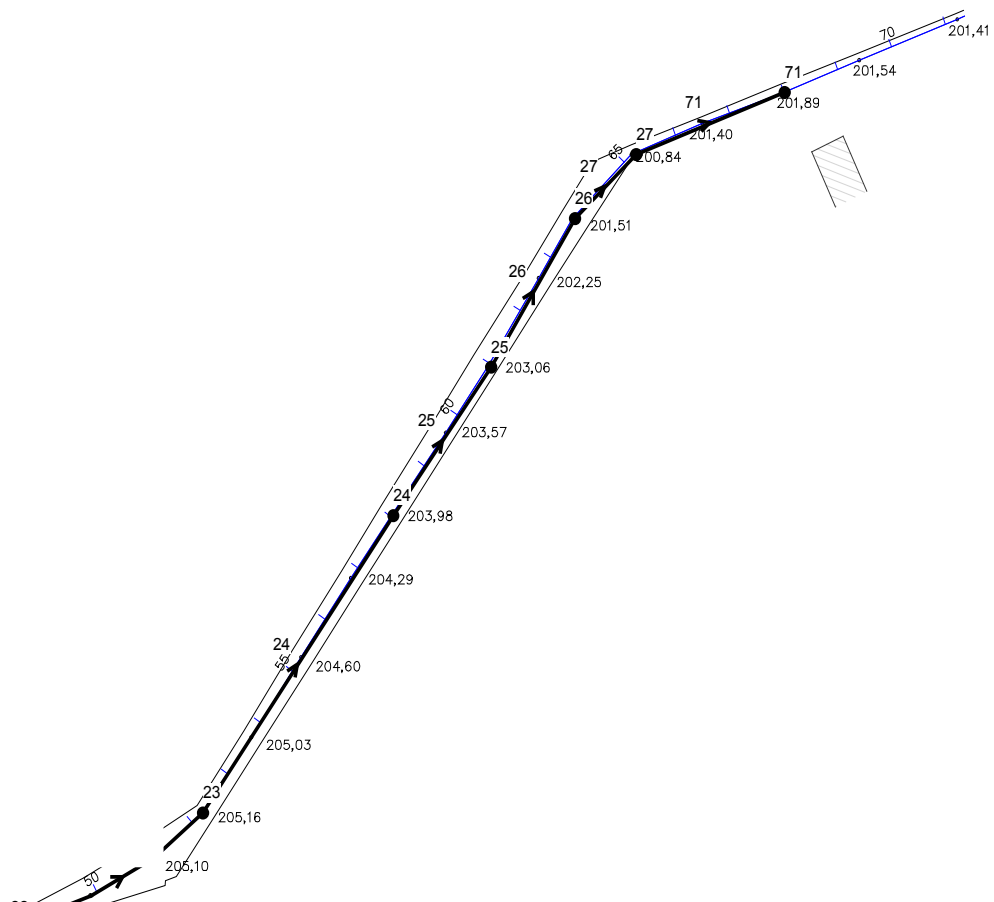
EPANET parcial 5 – Rede de Lajes 1
